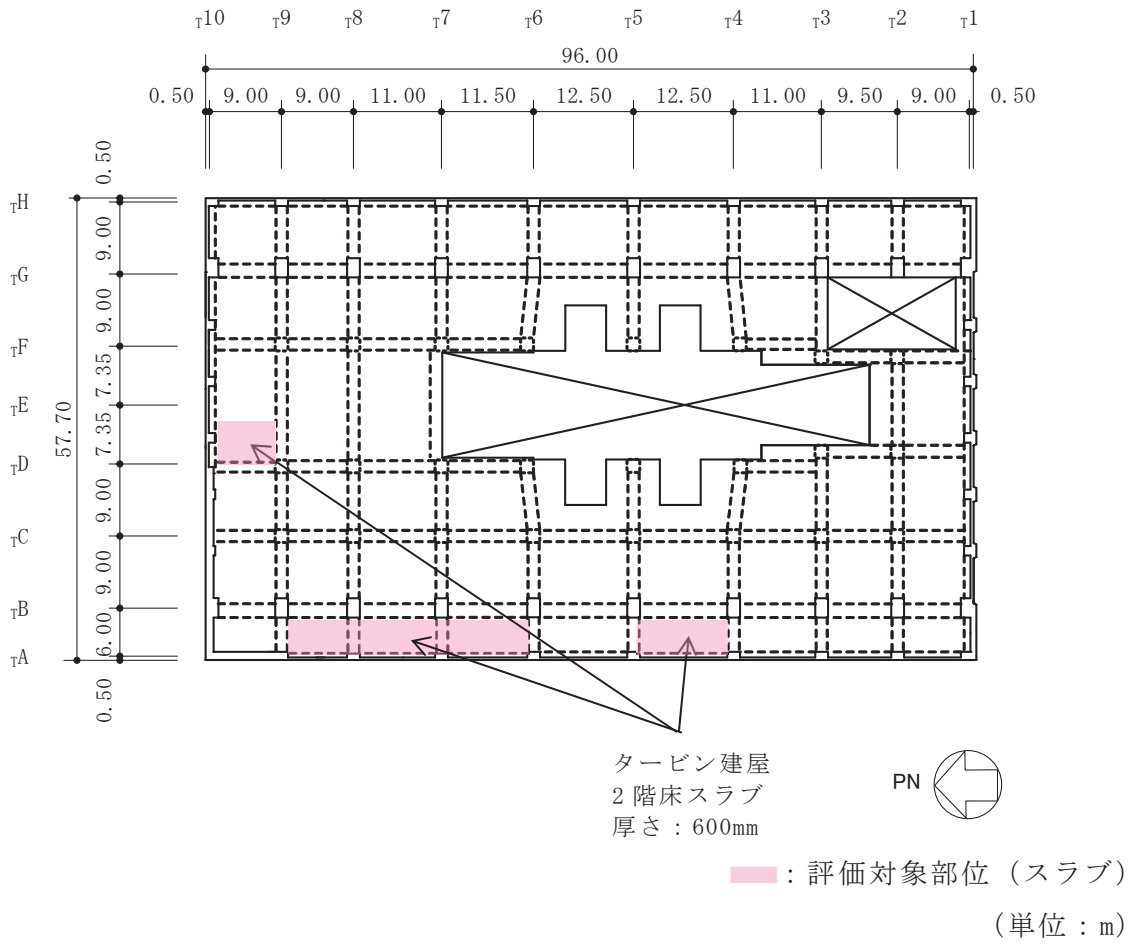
タービン建屋の概略平面図 (0. P. 24. 80m)
